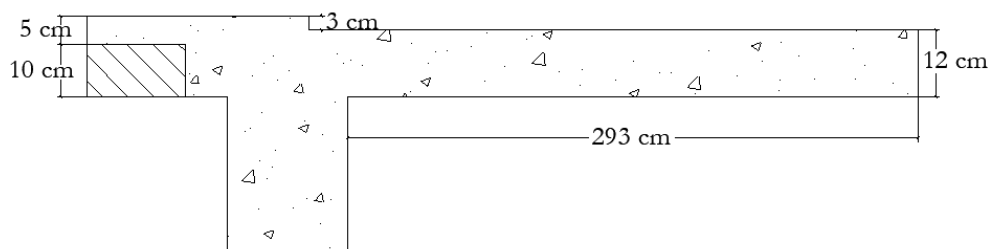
Seção transversal da laje. Fonte: Lima (1996).
